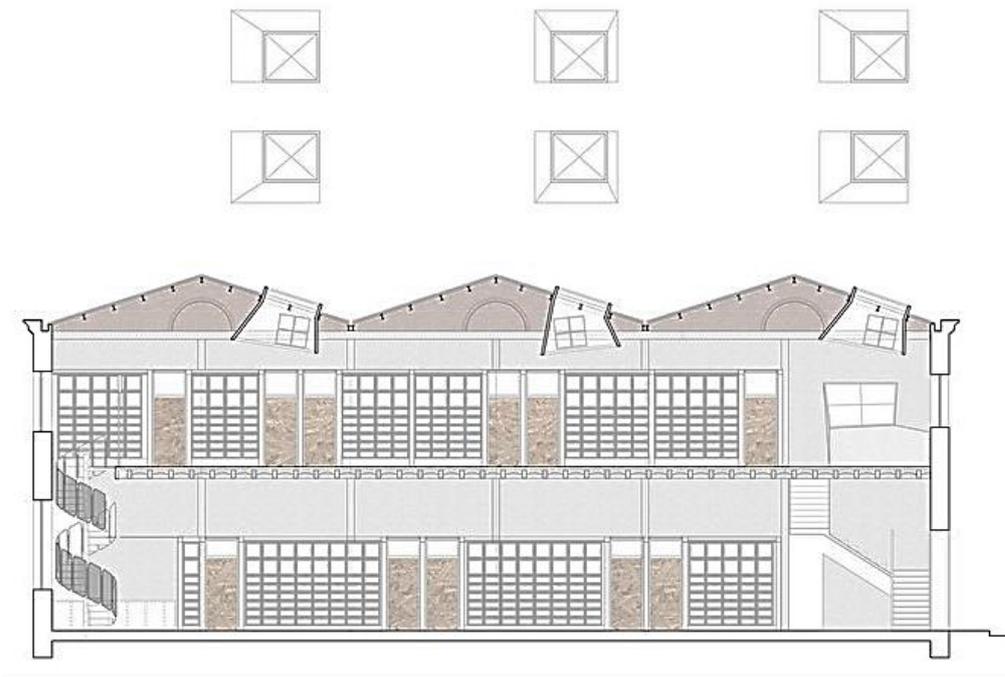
Centro de Drogodependencia Calella. Vista frontal.
